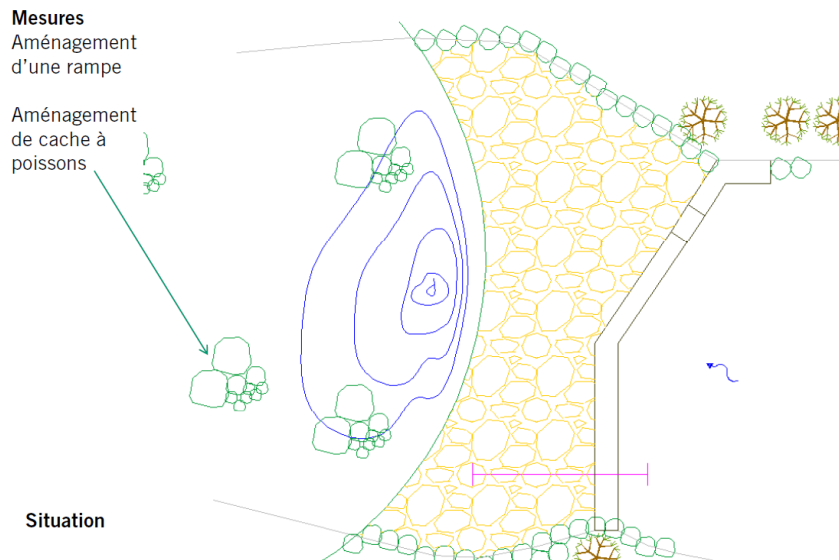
proposition de rampe à l'aval du barrage Raby. RWB 2007.
